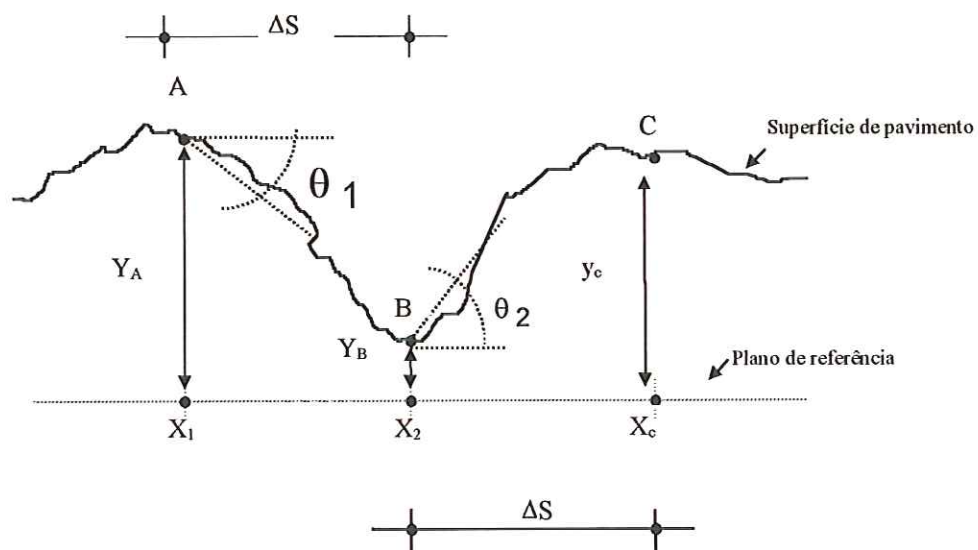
Perfil longitudinal de pavimento para análise da aceleração vertical. Adaptado de HASS, HUDSON & ZANIEWSKI (1994)
